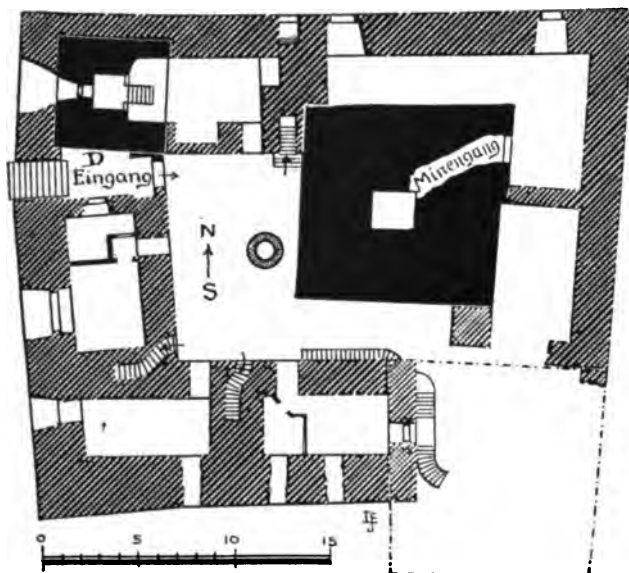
Rudesheim. Niederburg. Grundriss des Erdgeschosses nach v. Cohausen.
